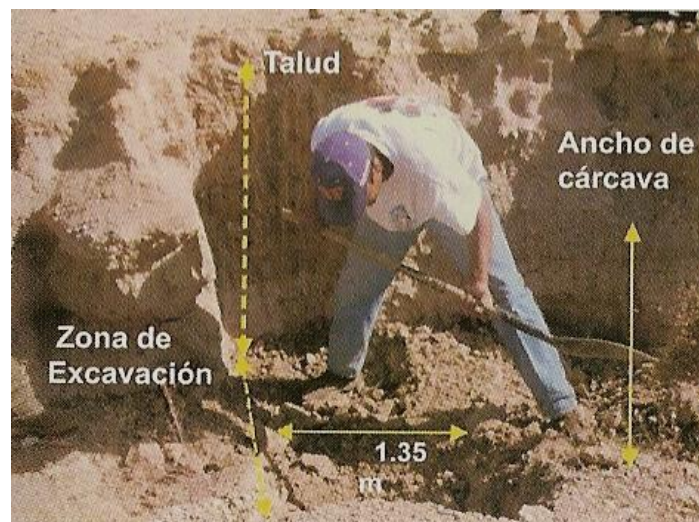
Secciones de excavación para empotramiento de la presa en una cárcava.
